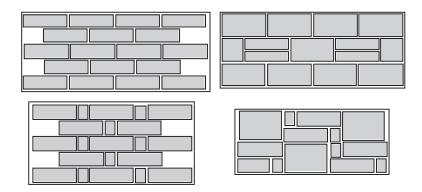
Ejemplos de aparejos de bloques de hormigón.
